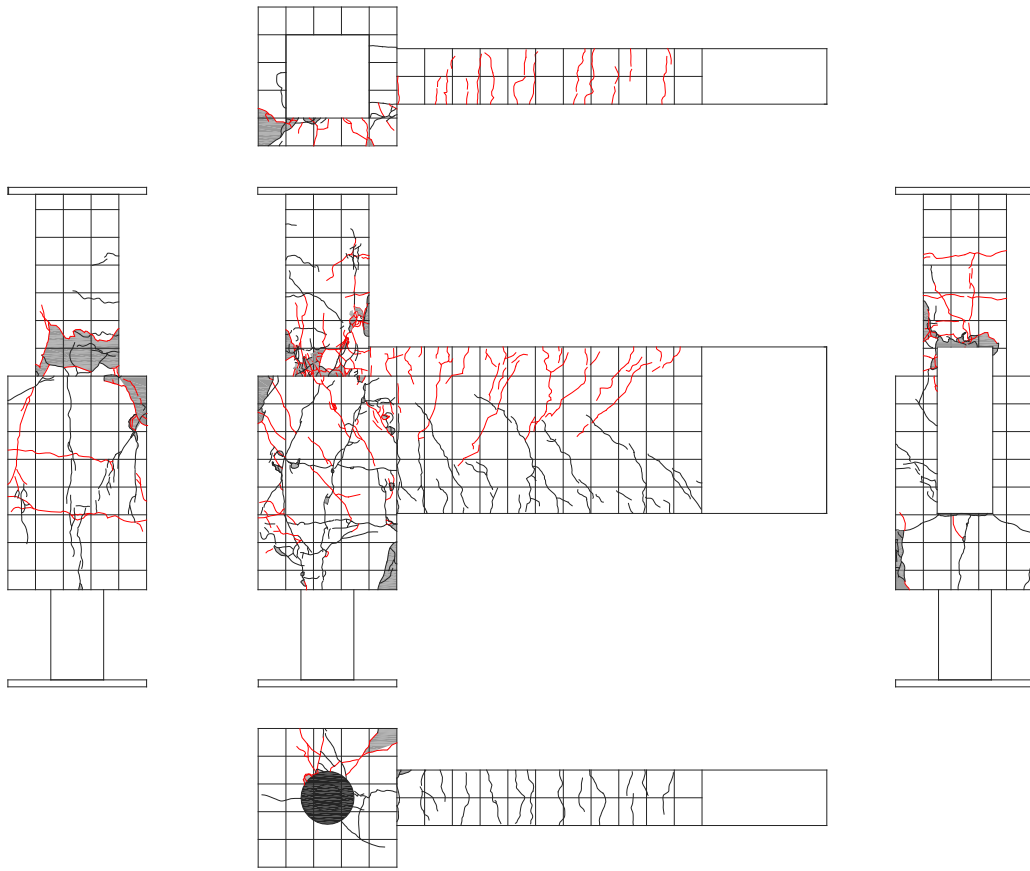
試験体 A-4 ひび割れ状況 (9Cycle)
